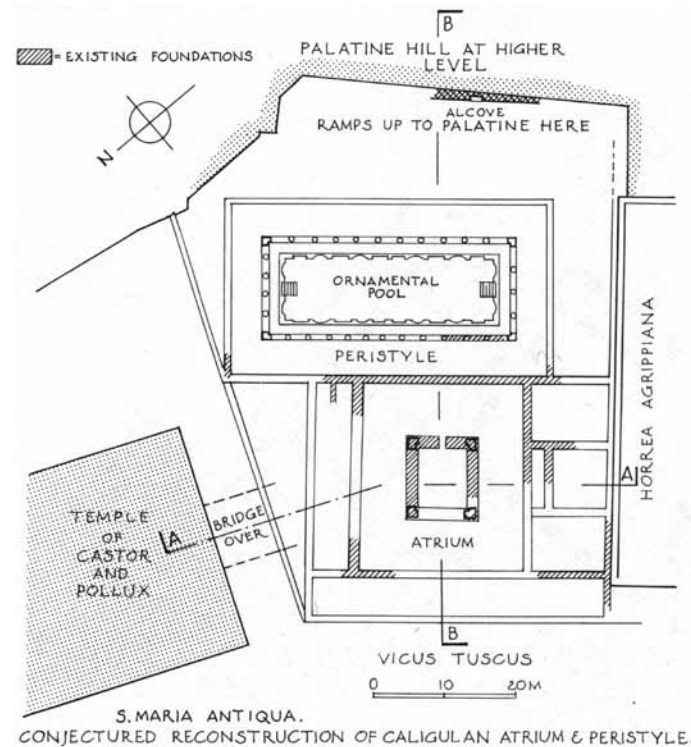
/138 Rekonstruierter Grundriss der *domus gai* von Caligula. Die schraffierten Flächen entsprechen den erhaltenen Fundamenten und dem Wandstück in der Rampe zum Palatin.
